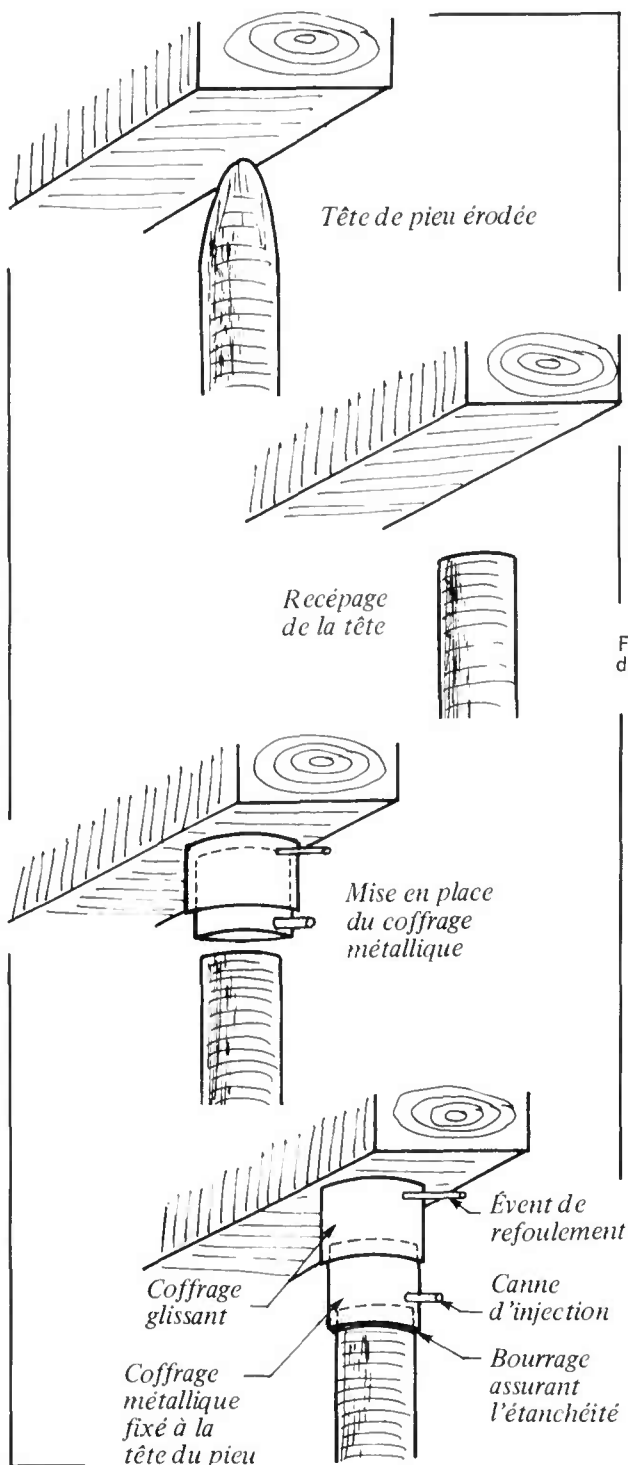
Restauration d'une tête de pieu en bois sous l'appui.
